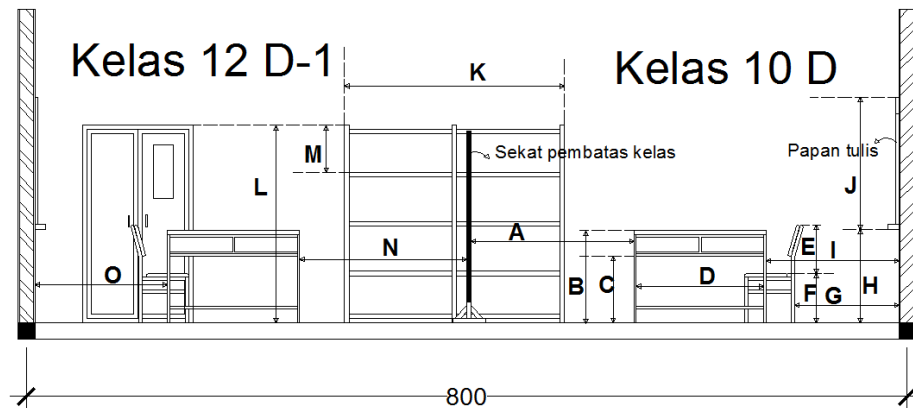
Gambar XXIX: Denah, sirkulasi dan potongan ruang kelas
